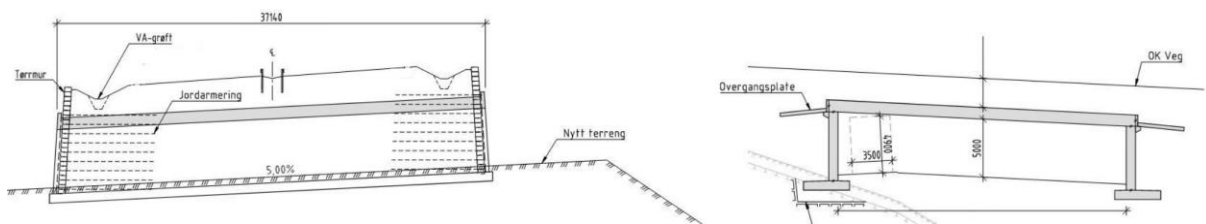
Typisk faunapassasje – kulvert over ny E18.
